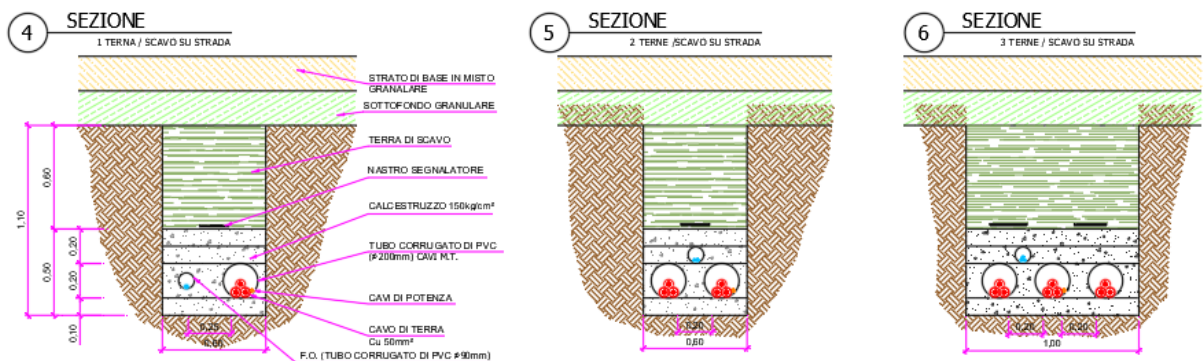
Sezione tipo di scavo su viabilità con o senza pavimentazione
